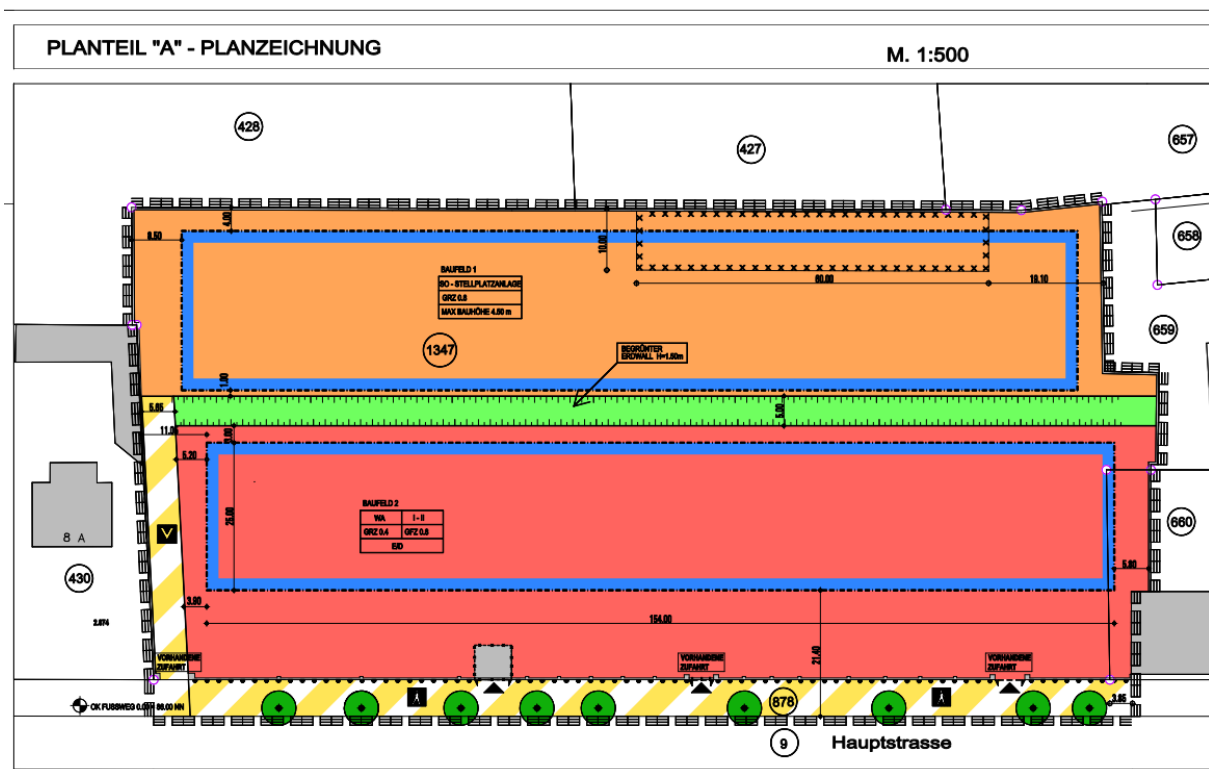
Ausschnitt aus dem Entwurf des Bebauungsplans Nr. 66/22, 03-2026
